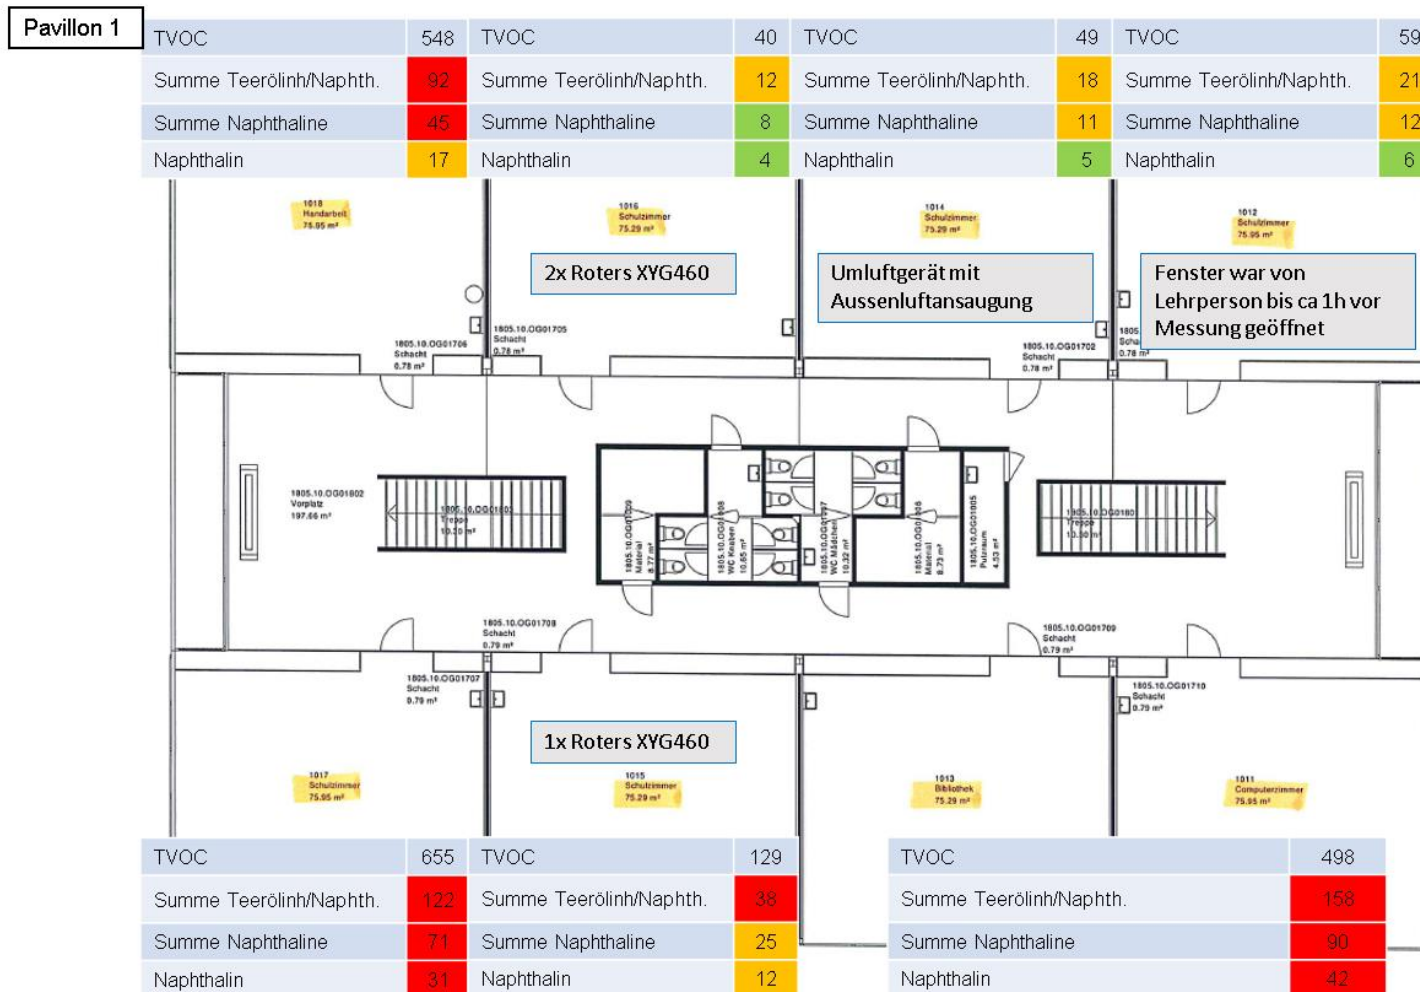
Grundriss 1: Pavillon 1, EG, Resultate Mai 2018
